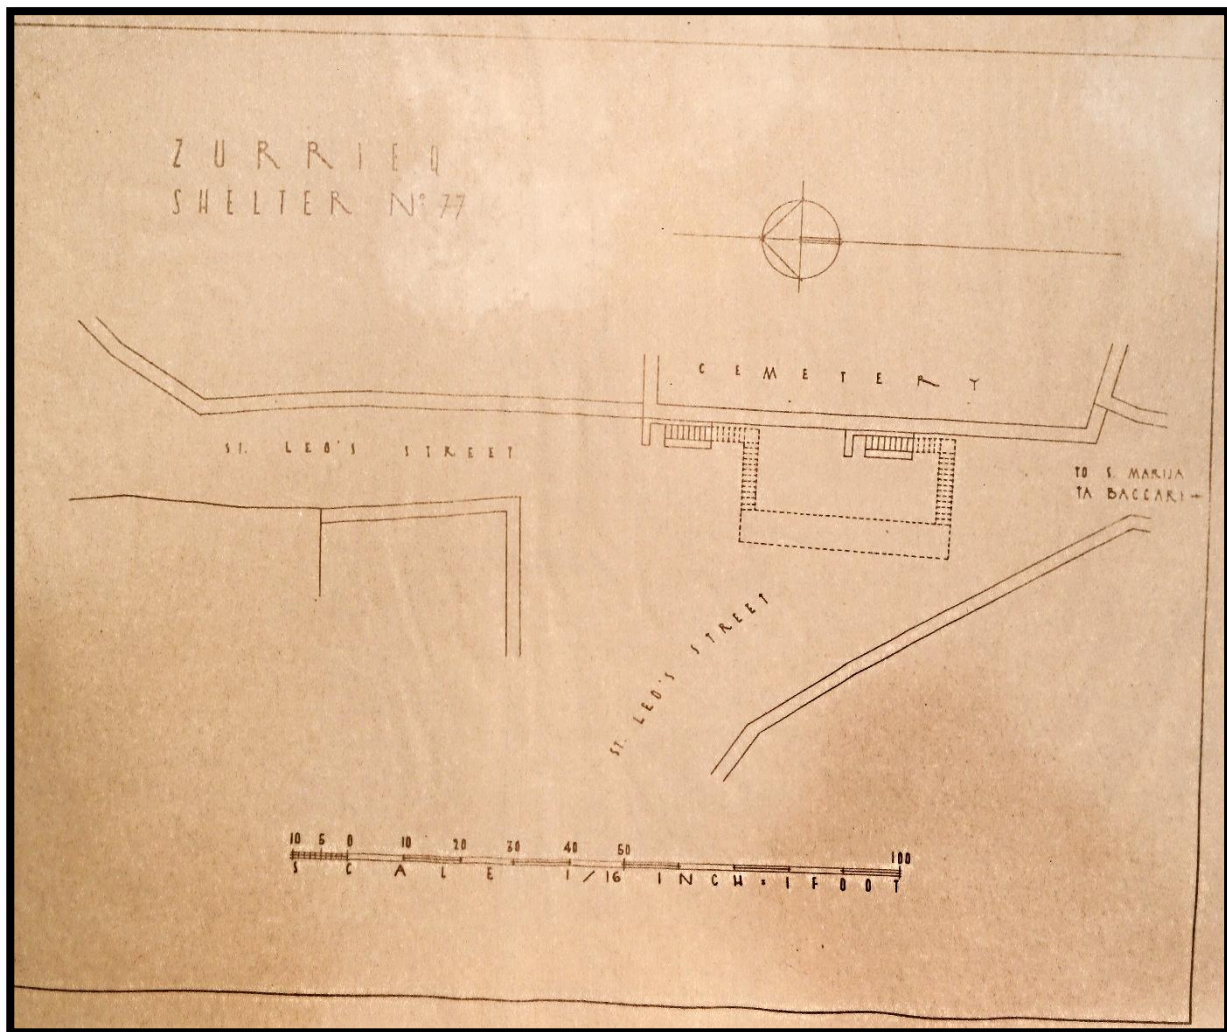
Planta do Abrigo nº77 "St. Leo's Street* – To S. Marija Ta Baccari"
